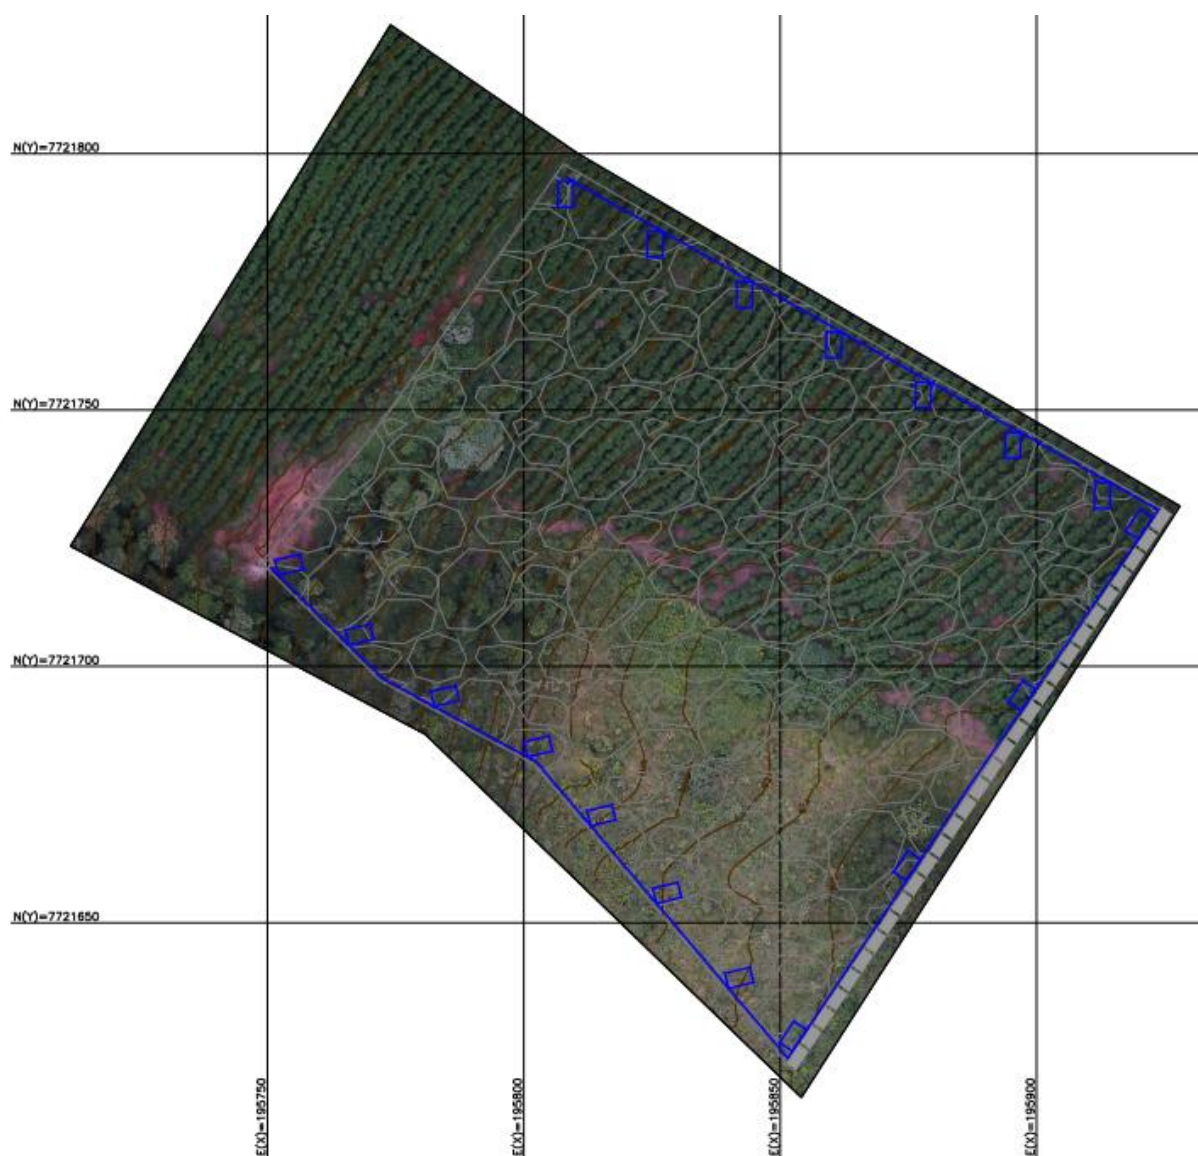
Pilha projetada e sistema de drenagem. Fonte: Planta topográfica planialtimétrica - drenagem.
